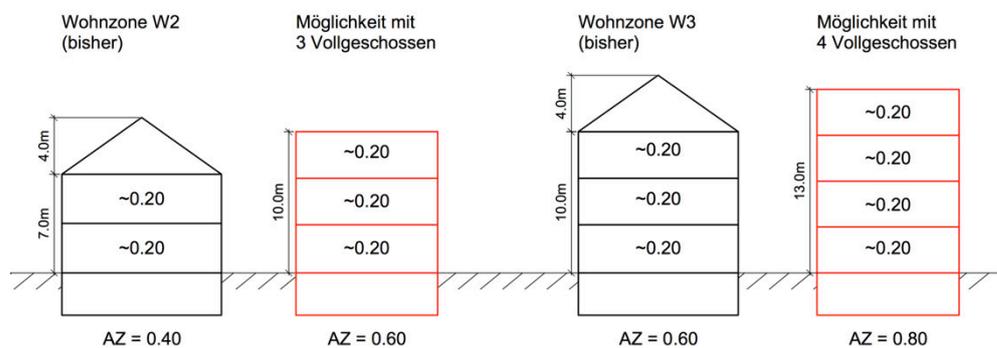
Verträglich eingepasste dreigeschossige Bauweise in der W2 bzw. viergeschossige Bauweise in der W3 als Anreiz zur Innenentwicklung (Quelle: PLANAR 2018)
